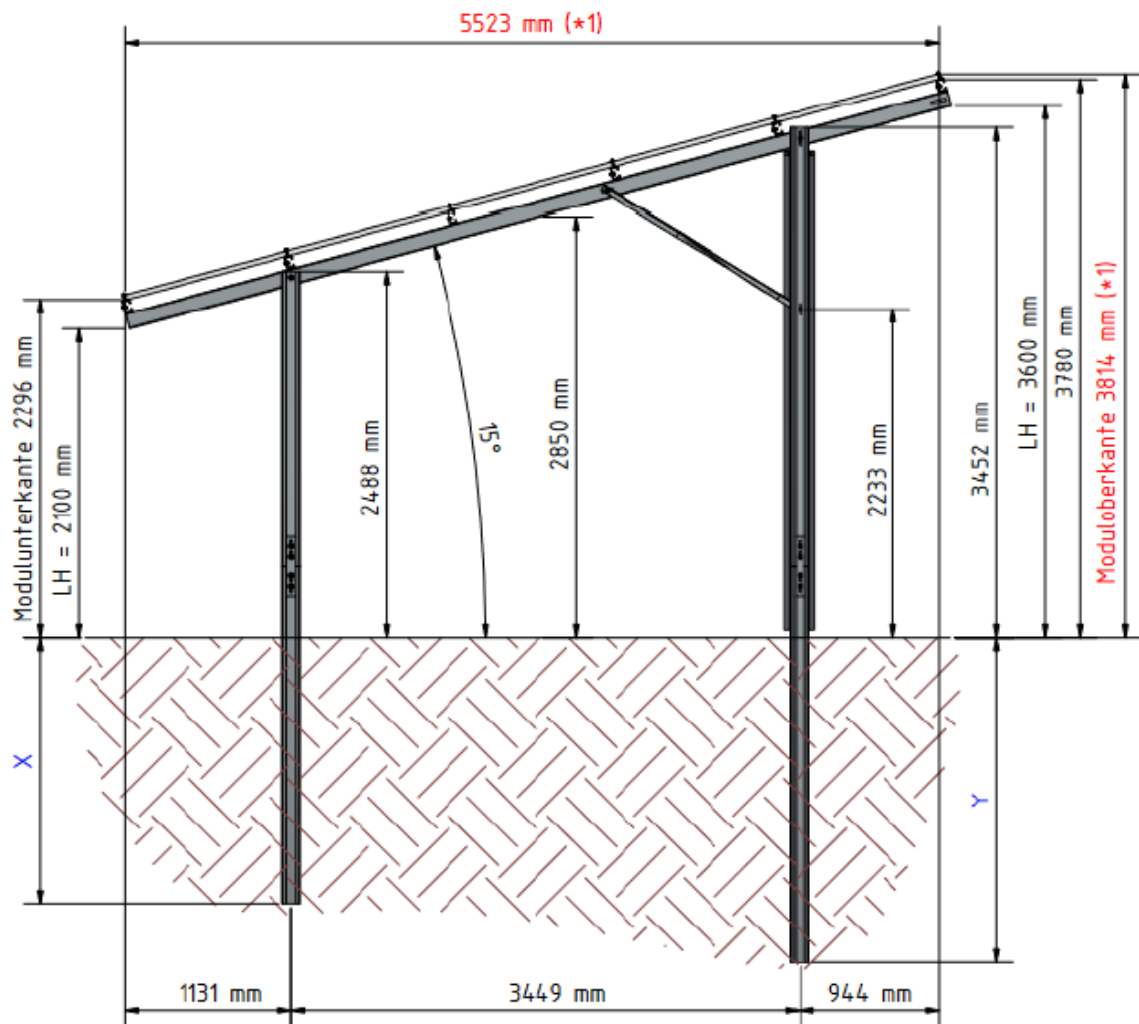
Modulquerschnitt (SUNfarming GmbH)
